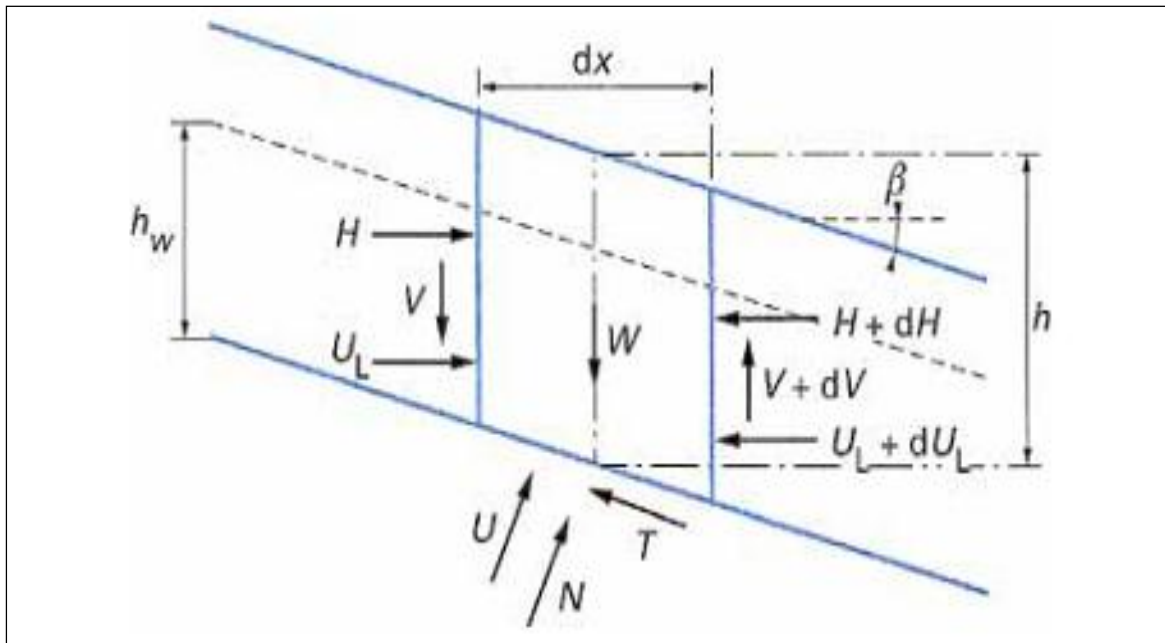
Glissement plan : équilibre d'un bloc [13]
